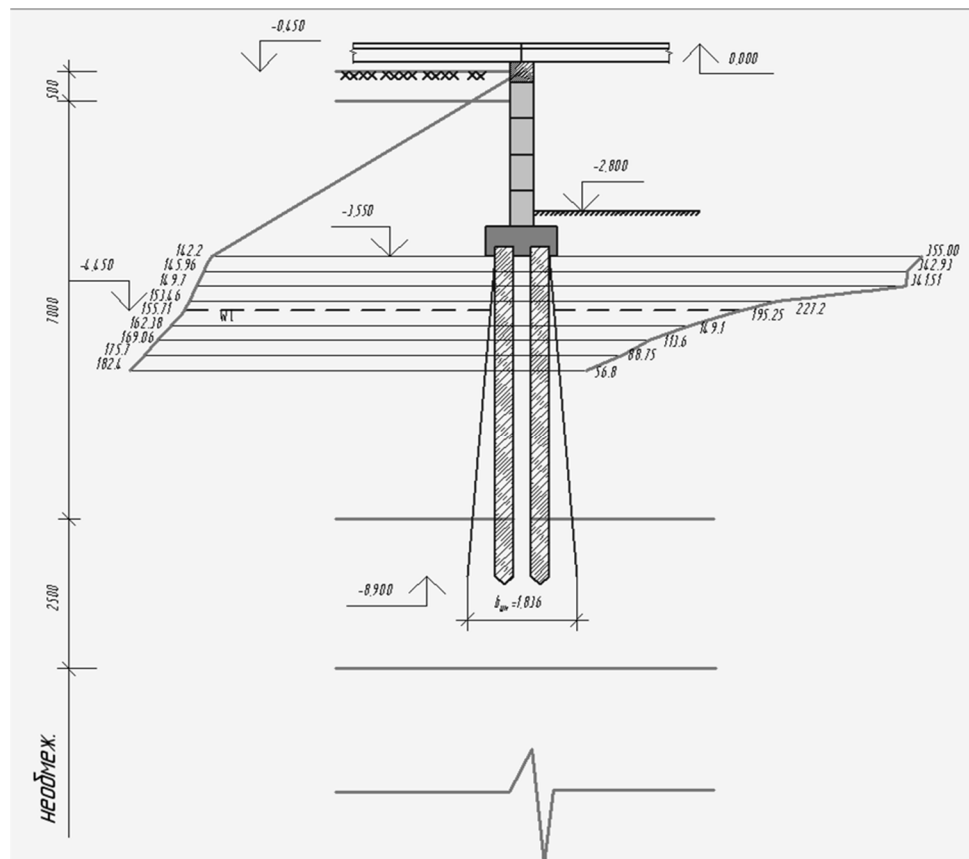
Схема до розрахунку пальового фундаменту
